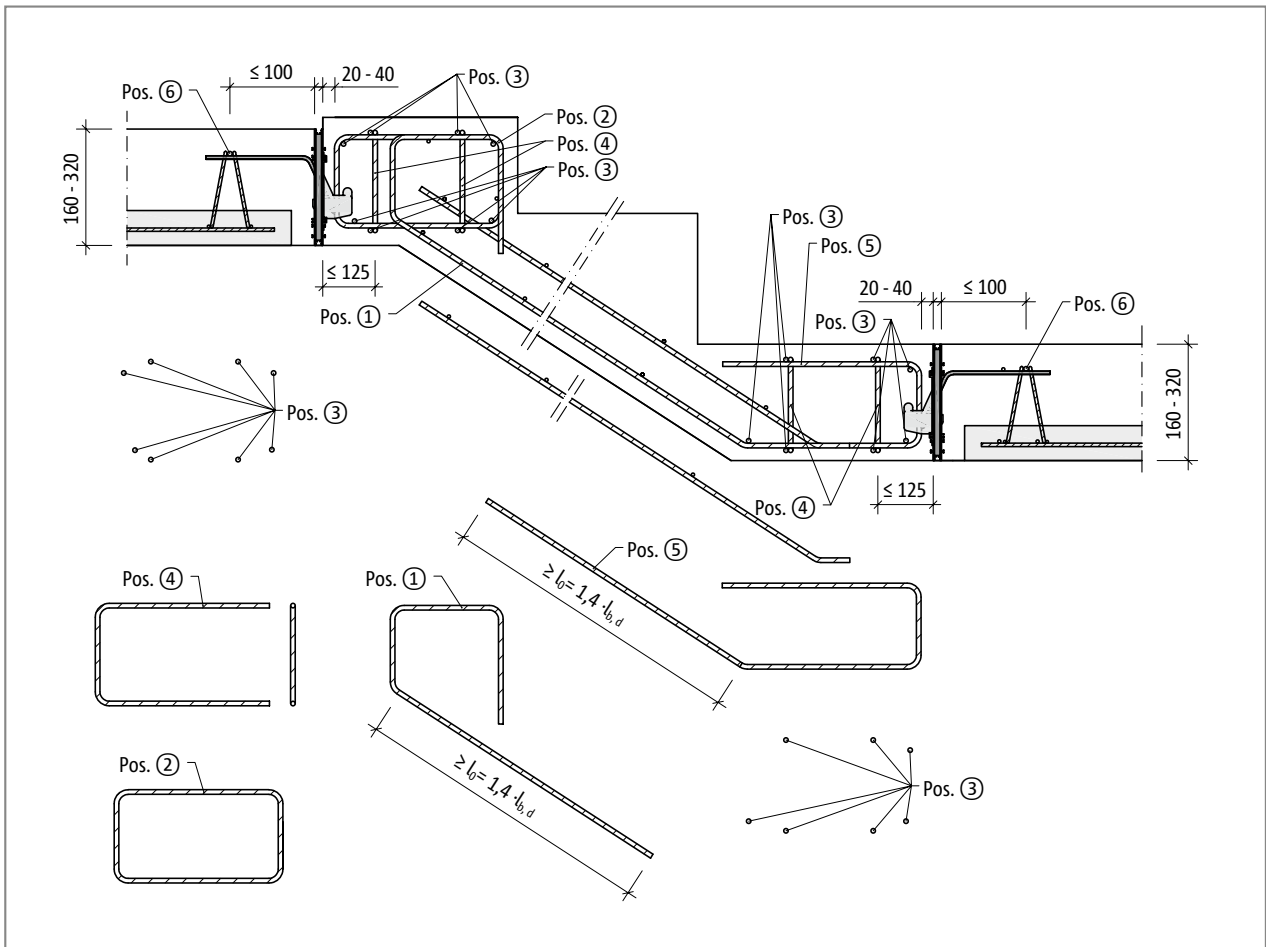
Schöck Tronsole® Typ T: Bauseitige Armierung bei Elementpodest
